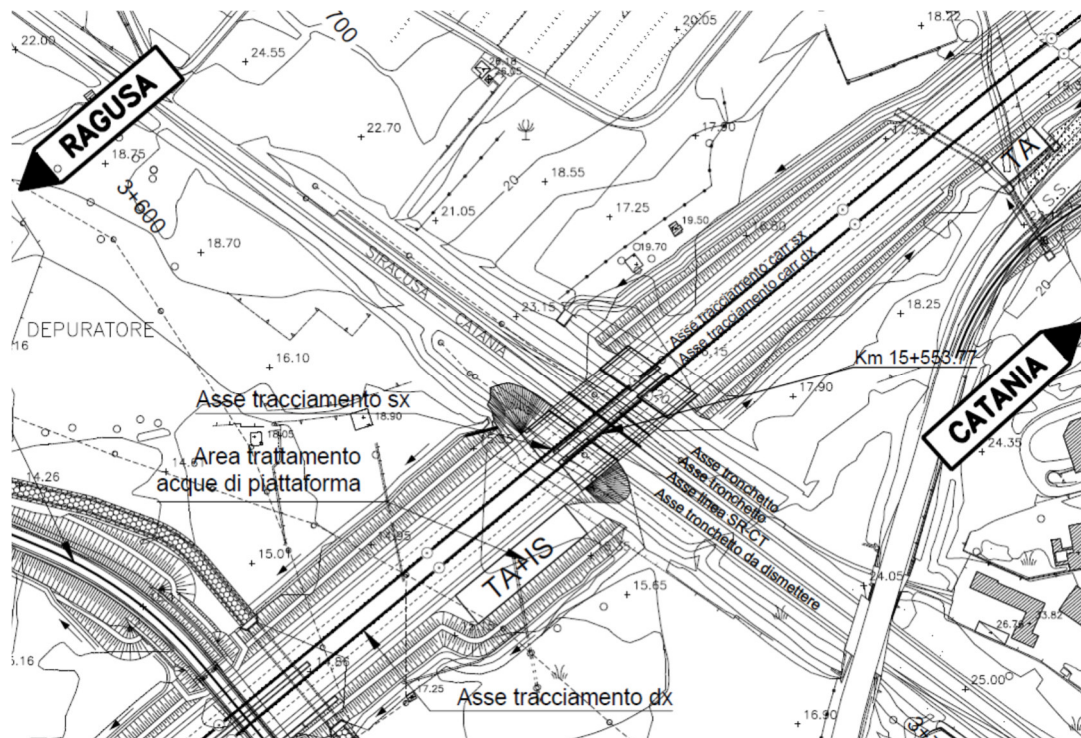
Stralcio planimetrico con individuazione dell'opera.
